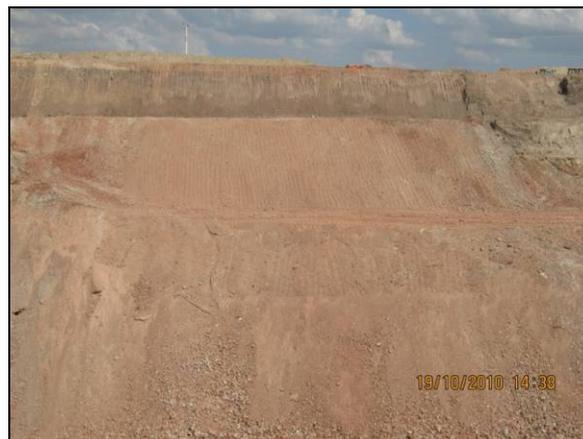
Vista frontal das bancadas implantadas no talude de corte do emboque do túnel Cuncas I (out/10).
